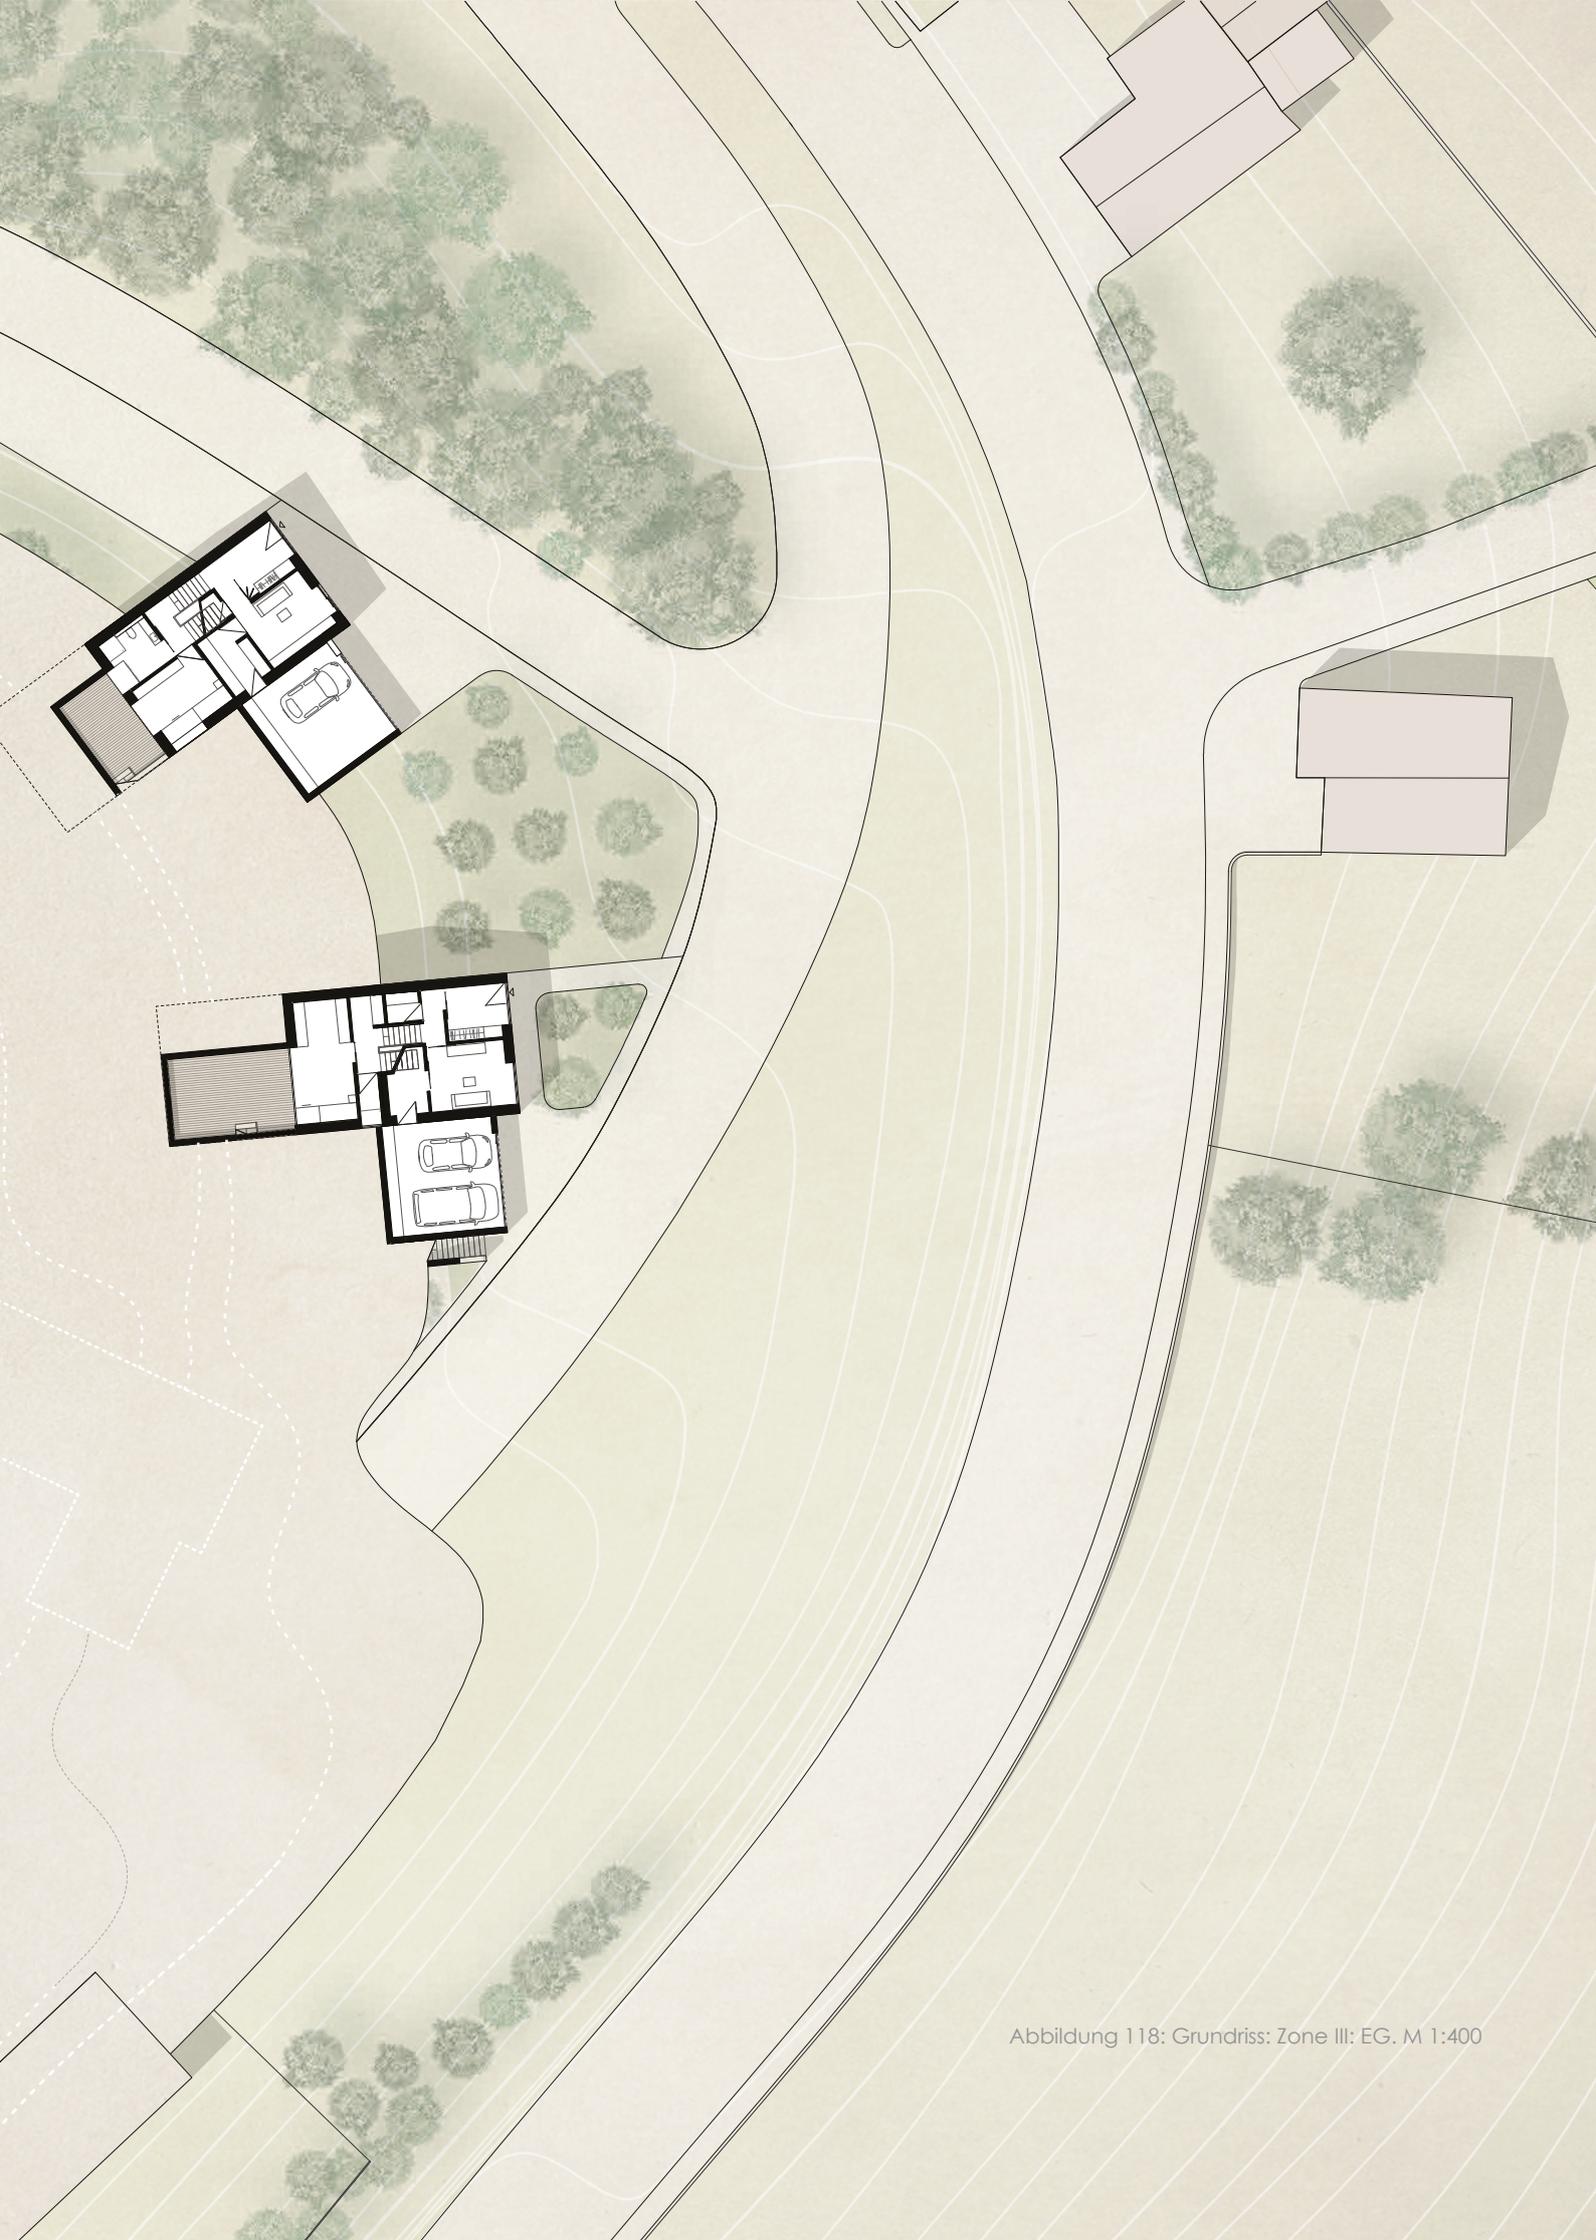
Grundriss: Zone III: EG. M 1:400
